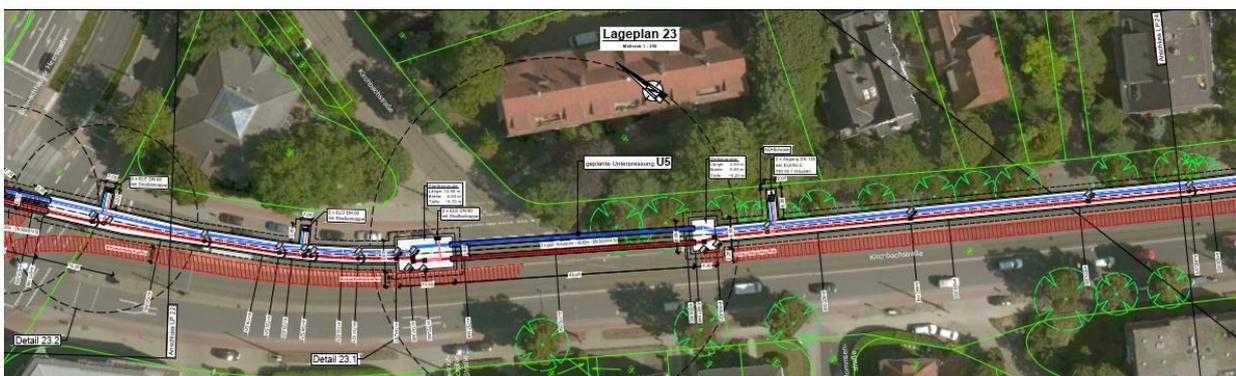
Abschnitt 13 - Kirchbachstraße Plan 2.2.23
